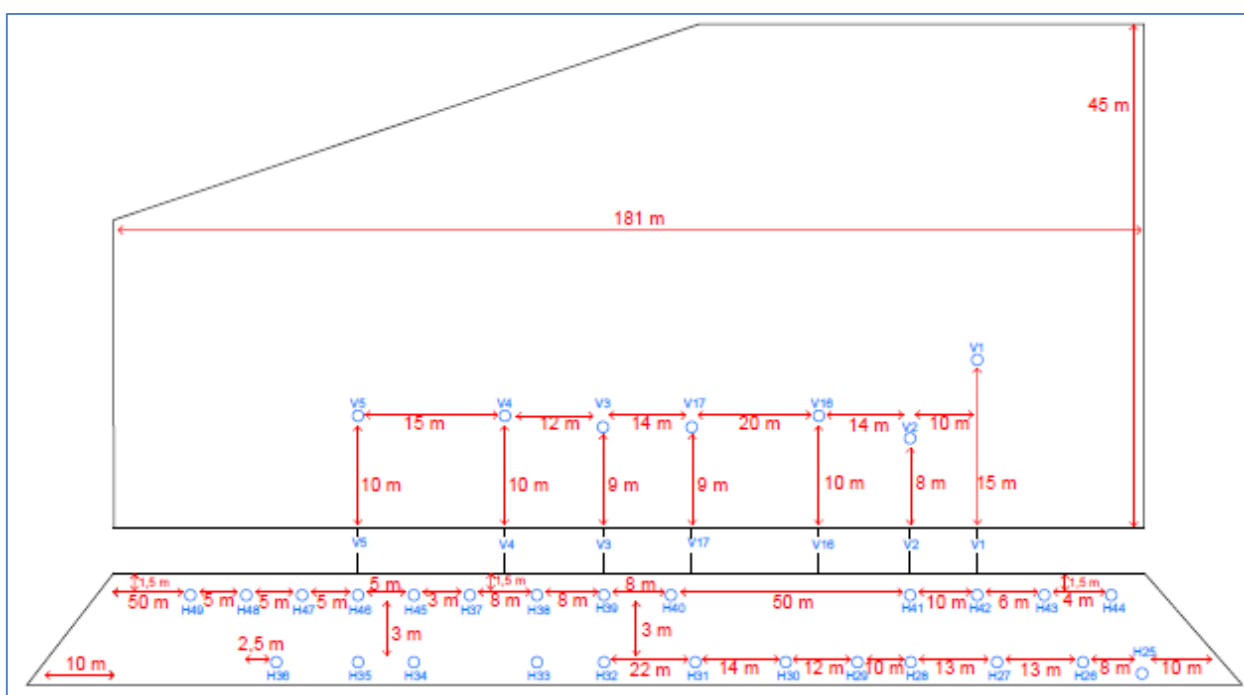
Esquema da zona piloto a estudar, com planta dos drenos verticais (V) e perfil dos drenos horizontais (H), sem escala.
